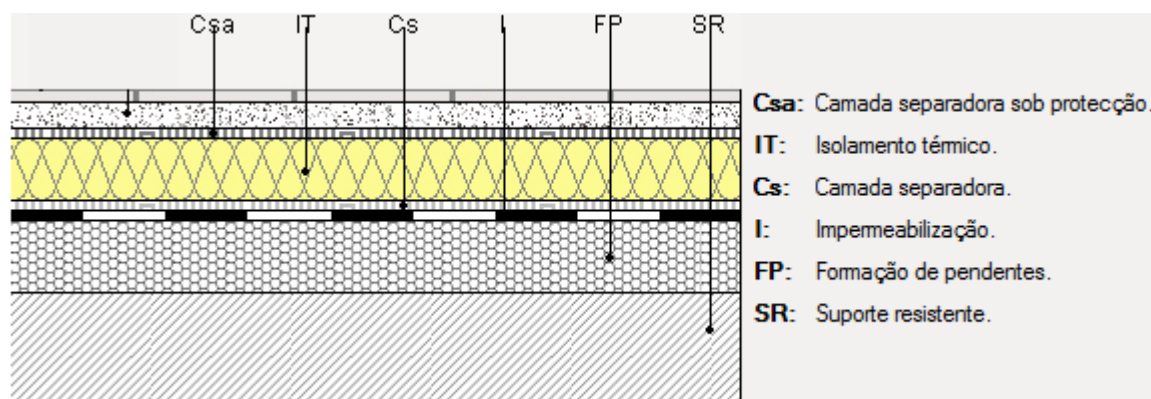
Cobertura plana acessível, não ventilada invertida, com pavimento fixo, impermeabilização através de lâminas asfálticas [37]
